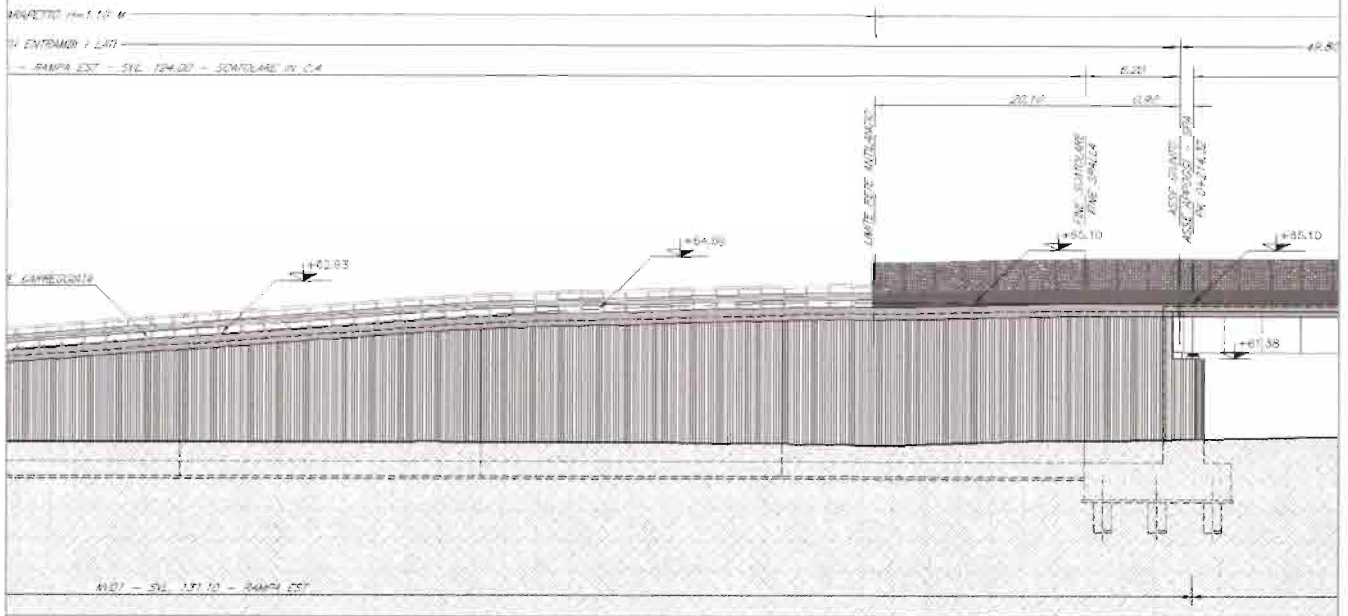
Sezione longitudinale - rampa Est, stralcio 1
